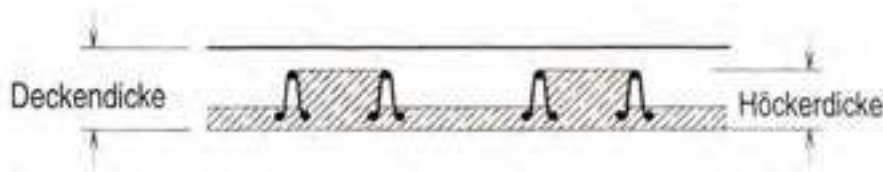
Zeichnung einer FILIGRAN-Höckerdecke (aus [36])
